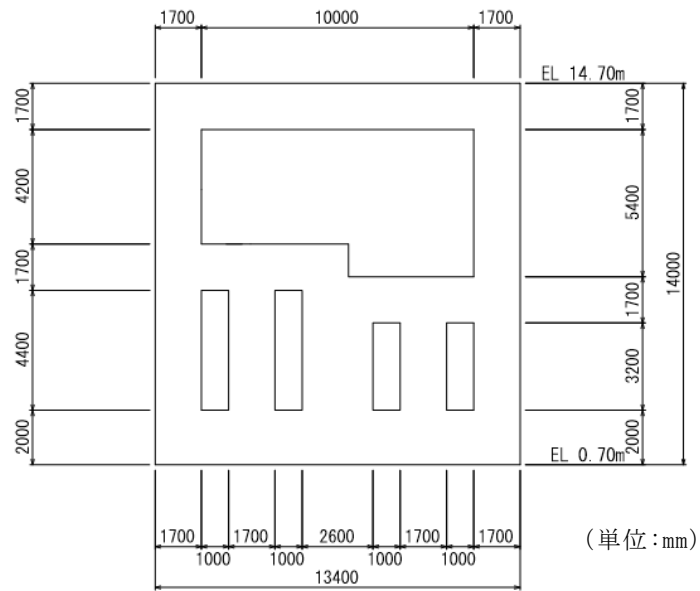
第 1 ベントフィルタ格納槽 断面図 (B-B 断面)
